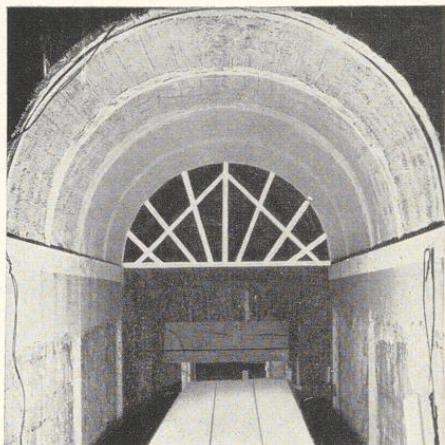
Tonnengewölbe, nach Pariserleisten teilweise fertig grundiert. Die Gipslehrnen werden mit dem Lehrbogen auf dem ausgedrückten Grund angelegt
